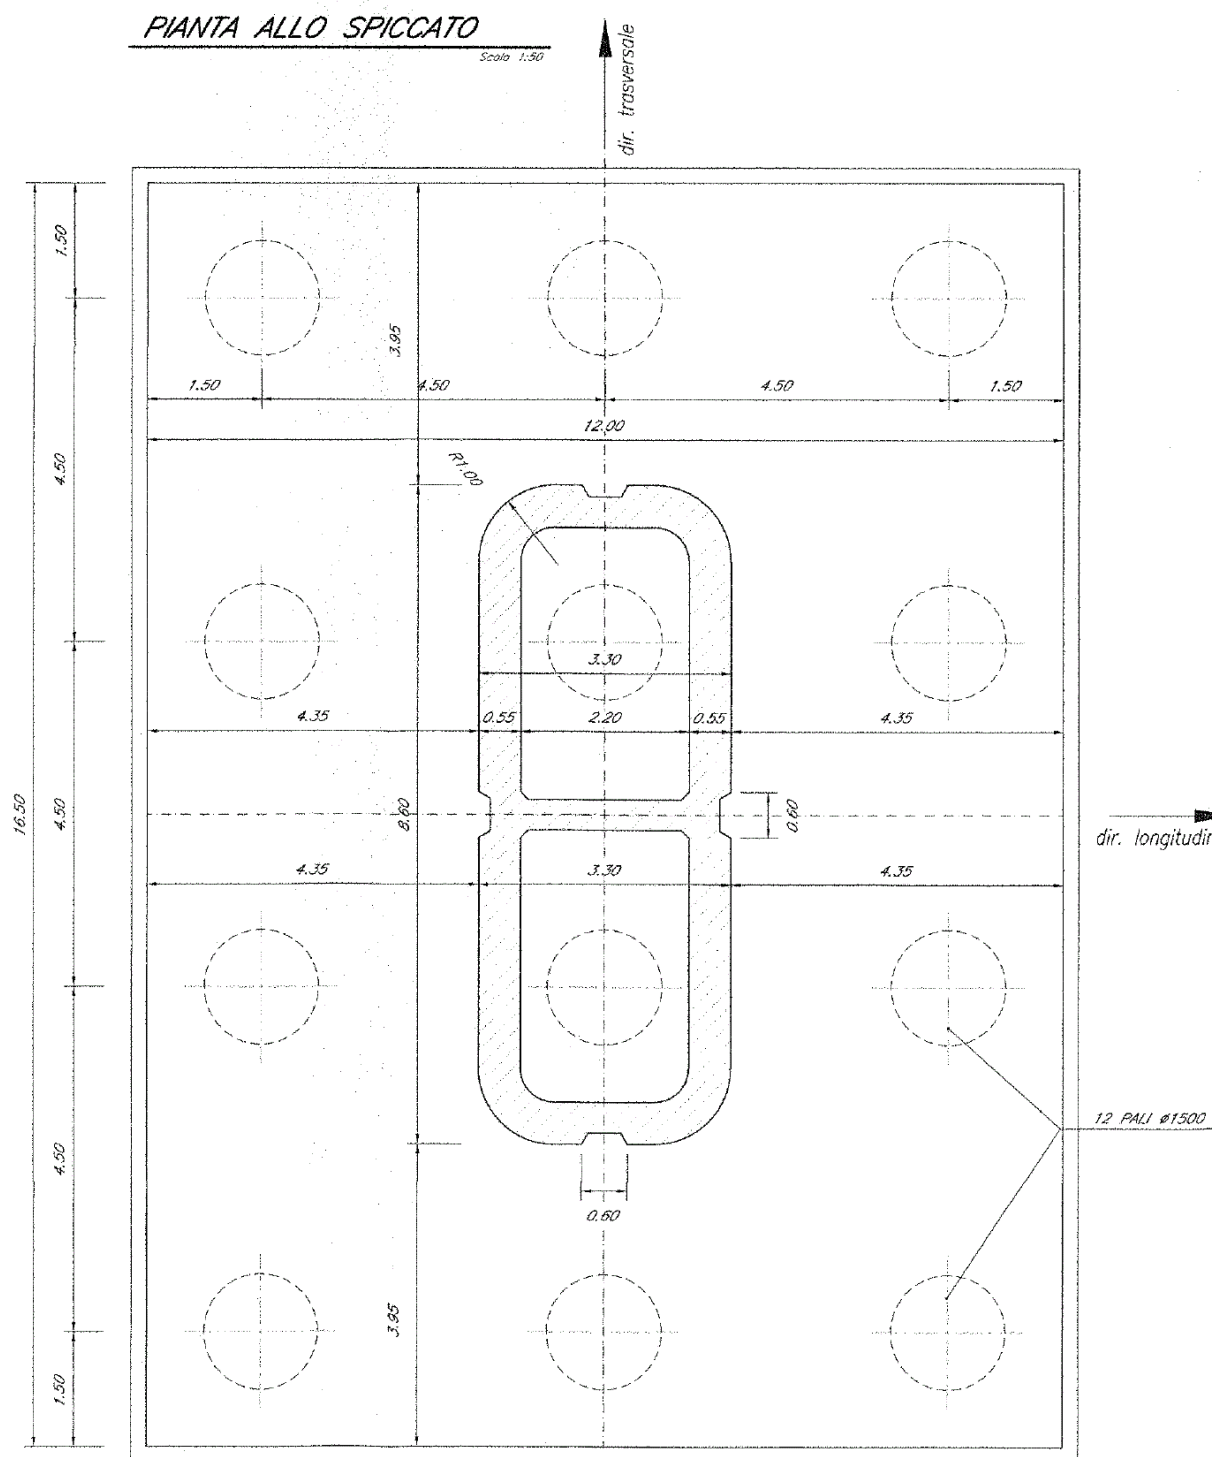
Plinto di fondazione e pali, vista in pianta - Sezione del fusto pila [m]
